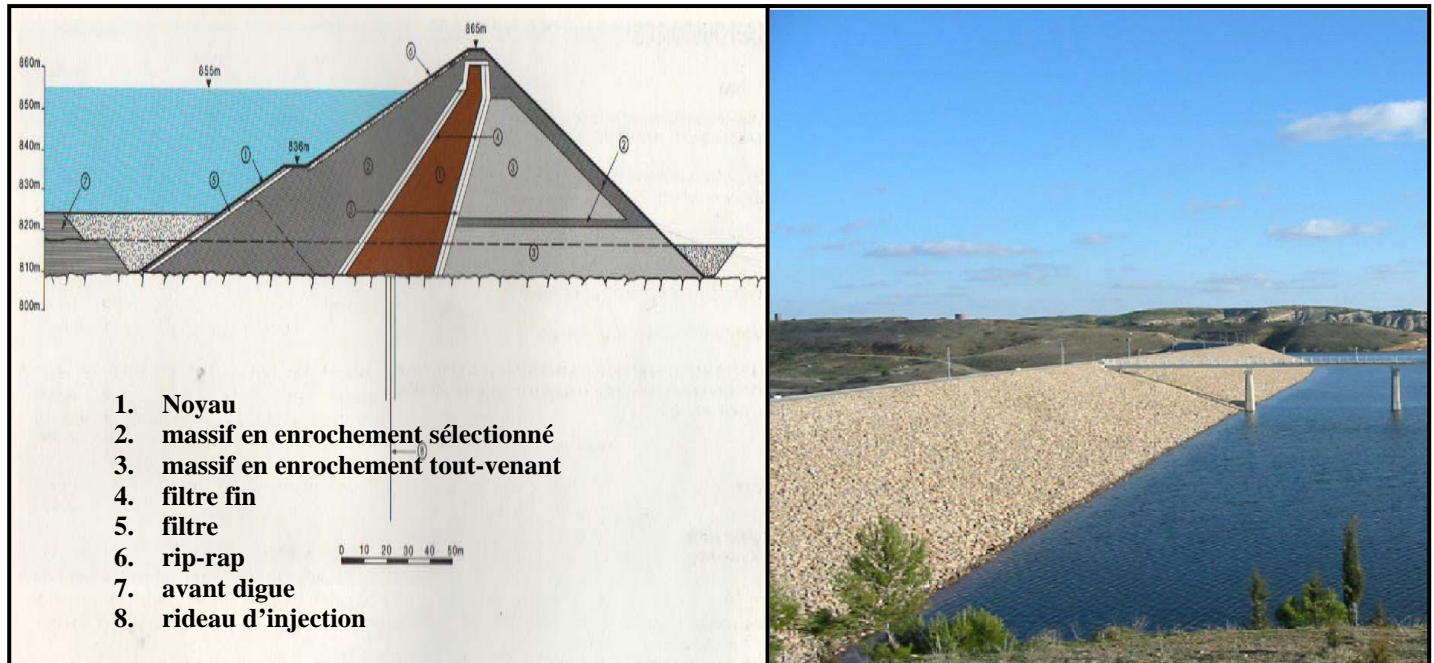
Photo de la digue principale et coupe en travers du barrage de Ain zada(d'après ANBT)
